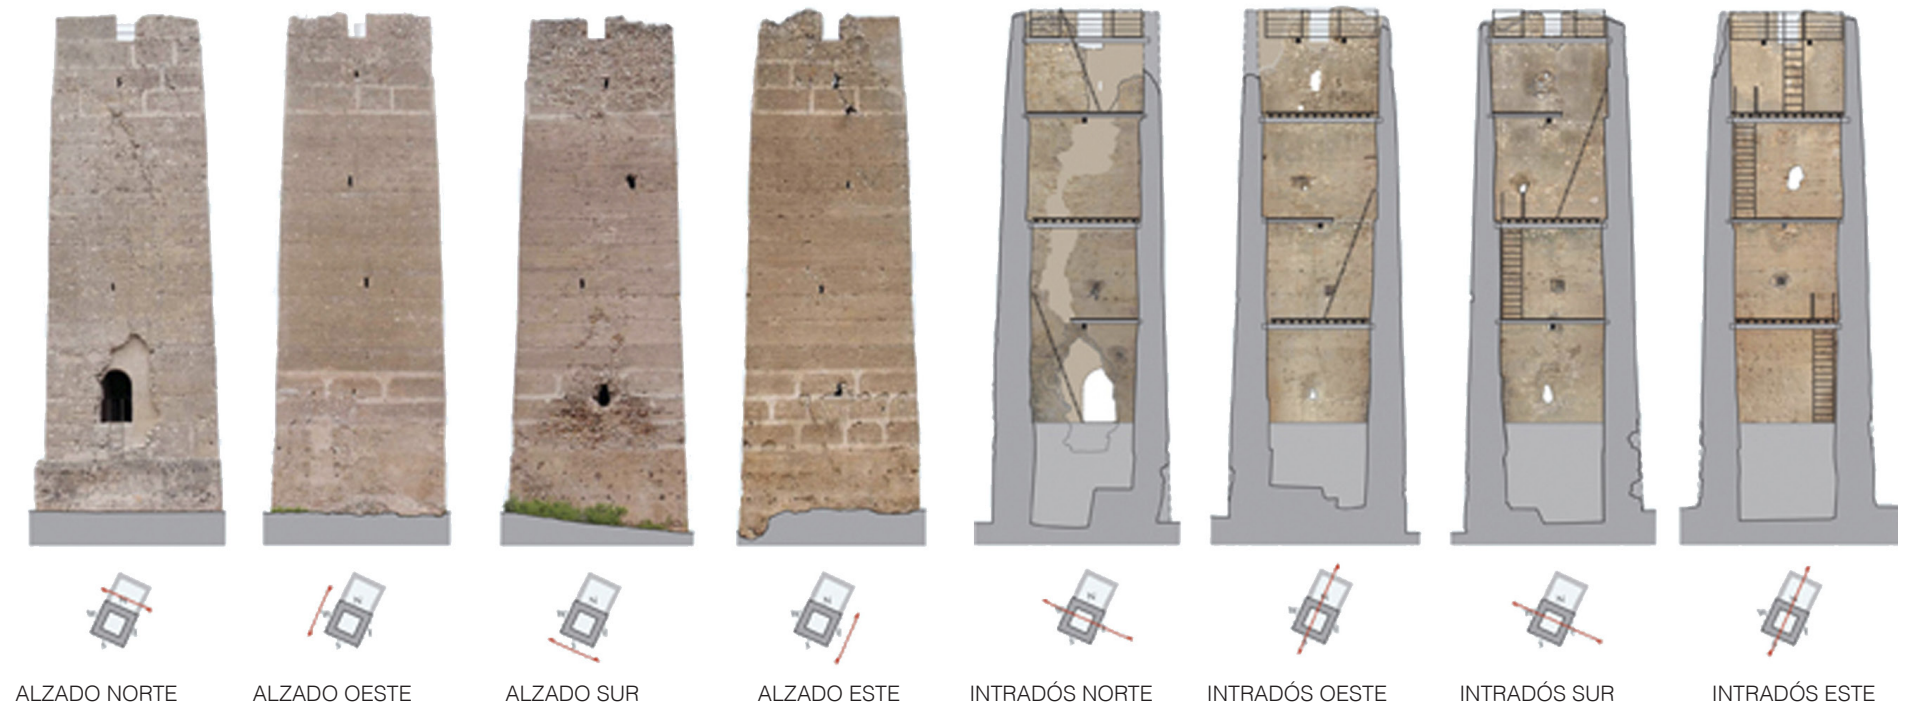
Alzados y secciones del estado posterior a la restauración de la torre Bofilla. (Según Mileto y Vegas)
